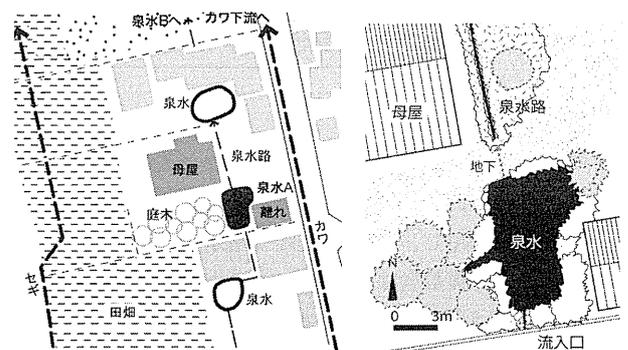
泉水路 配置と給排水経路 図 3-14 泉水 A 平面図
